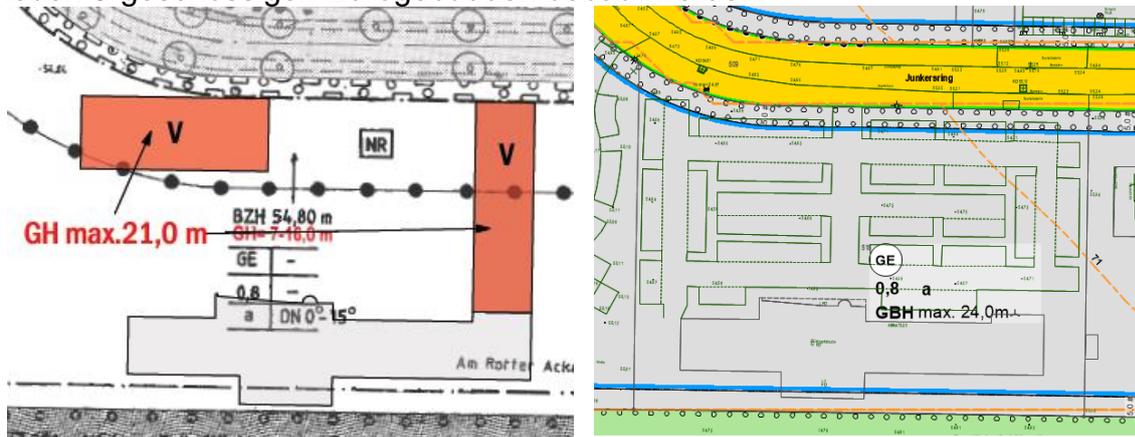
+ 8, geplante Gebäude und Änderung des Planes im Bereich Junkersring 33
